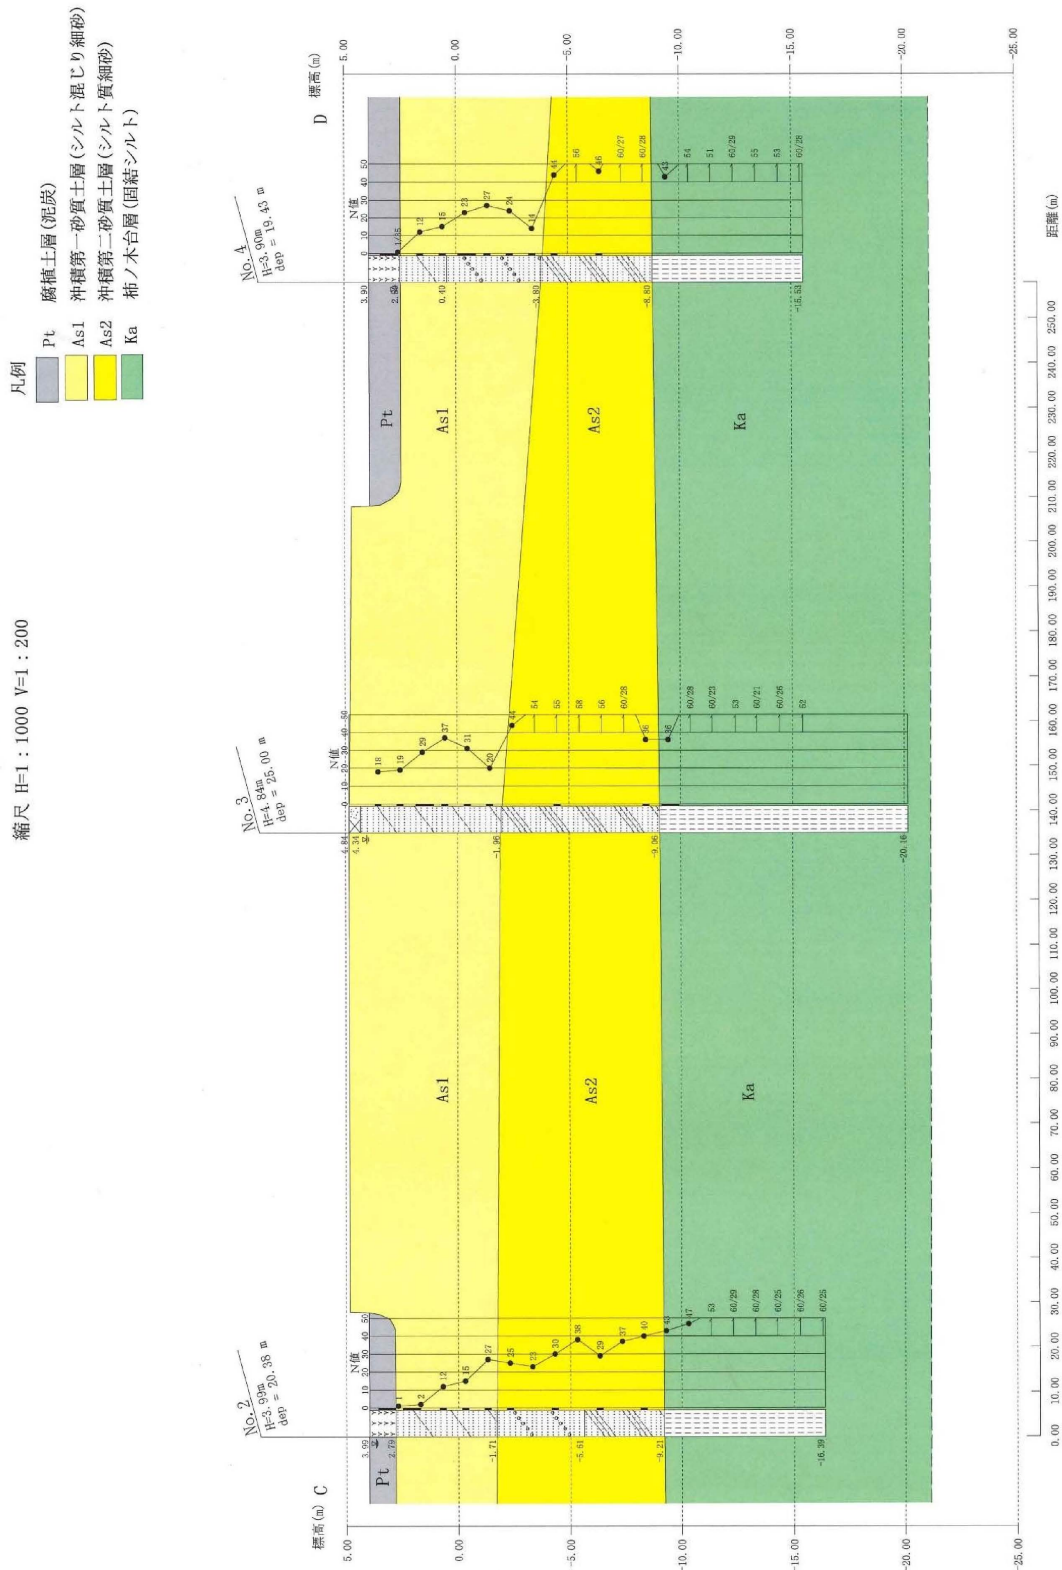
(2) 都市計画対象事業実施区域の地質想定断面図 (図 7.2.8-3 再掲)
